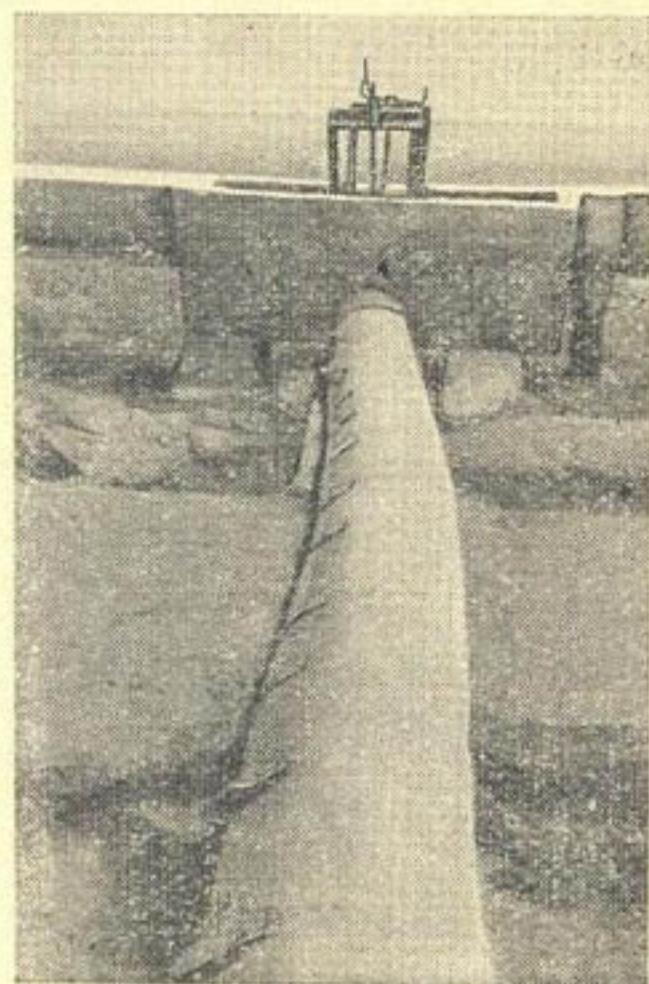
Гибкий трубопровод диаметром 400 мм, подключенный к гидранту лотка.
